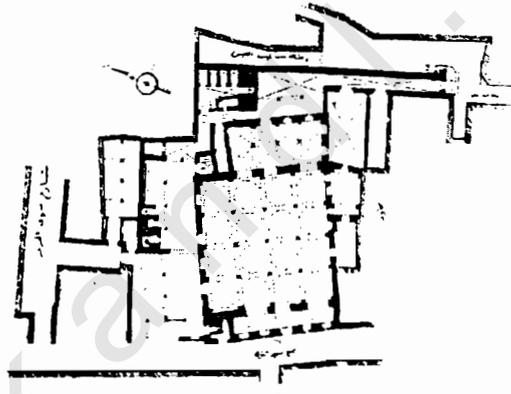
مسقط أفقي لجامع النخلي عن الموسوعة (الجزء الأول).
